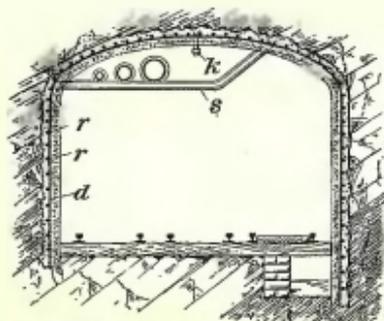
Streckenausbau in Eisenbeton mit Korbboegen.
